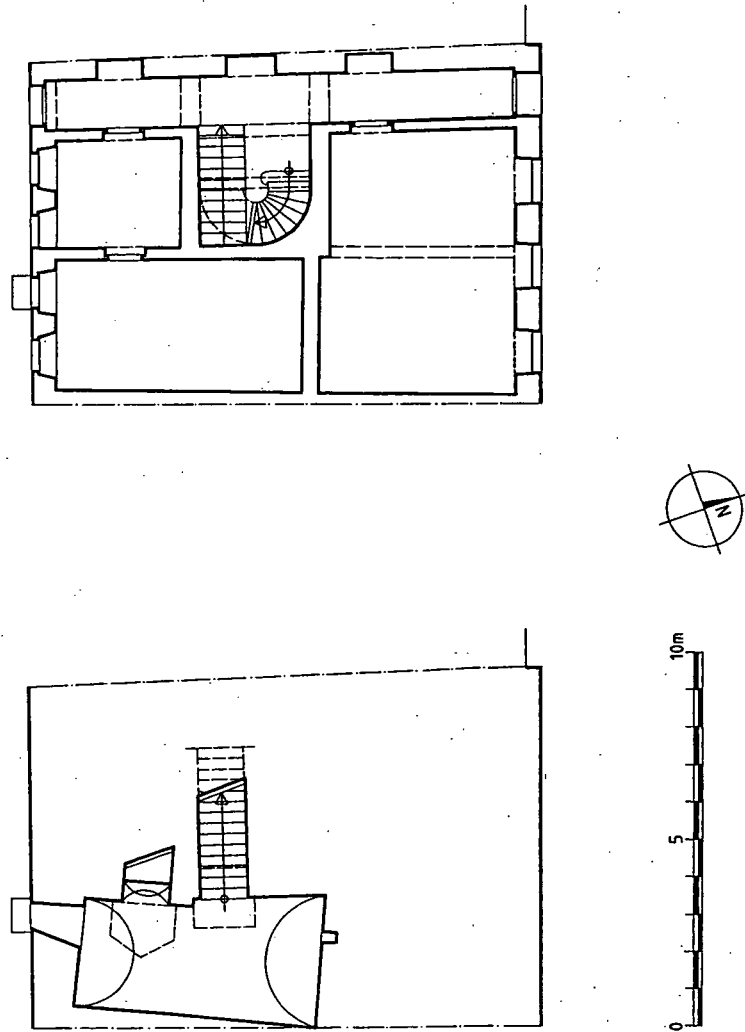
Kirchenplatz 7 – Grundrisse Keller, Erdgeschoss (1:200).
